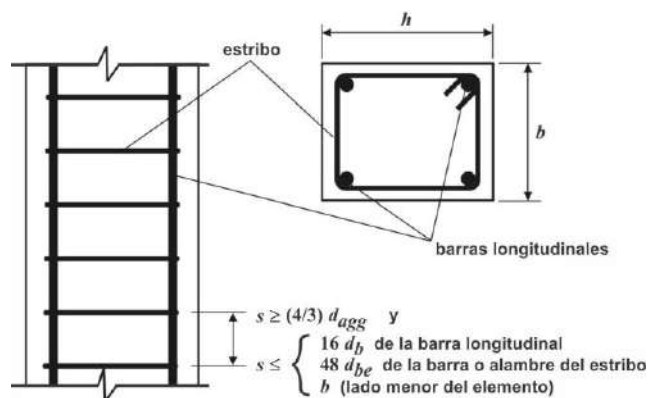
Separación vertical de los estribos cerrados.
